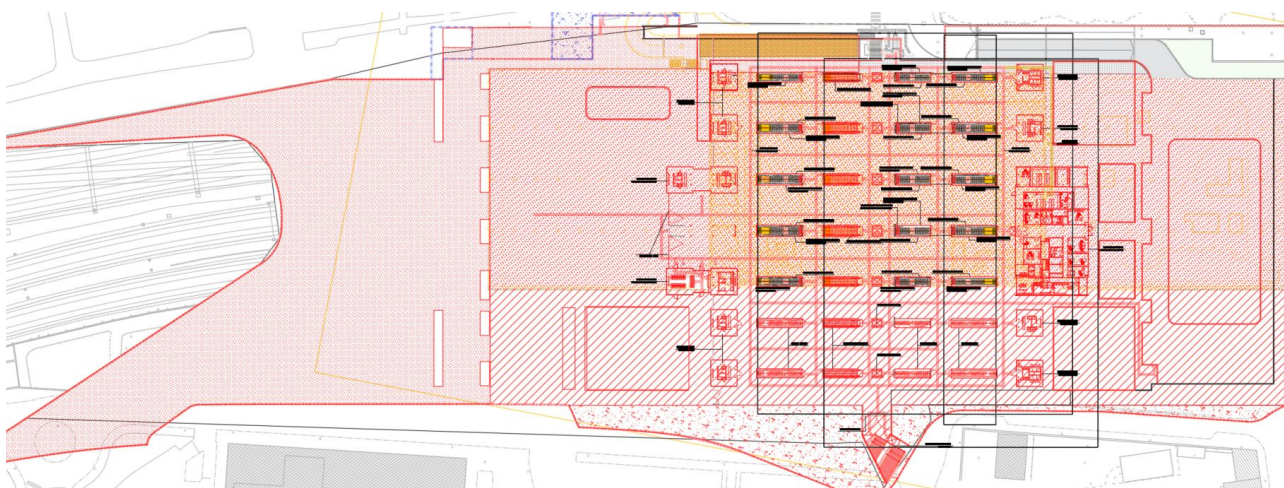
Planimetria demolizioni Piano Ingressi (demolizioni in giallo)
